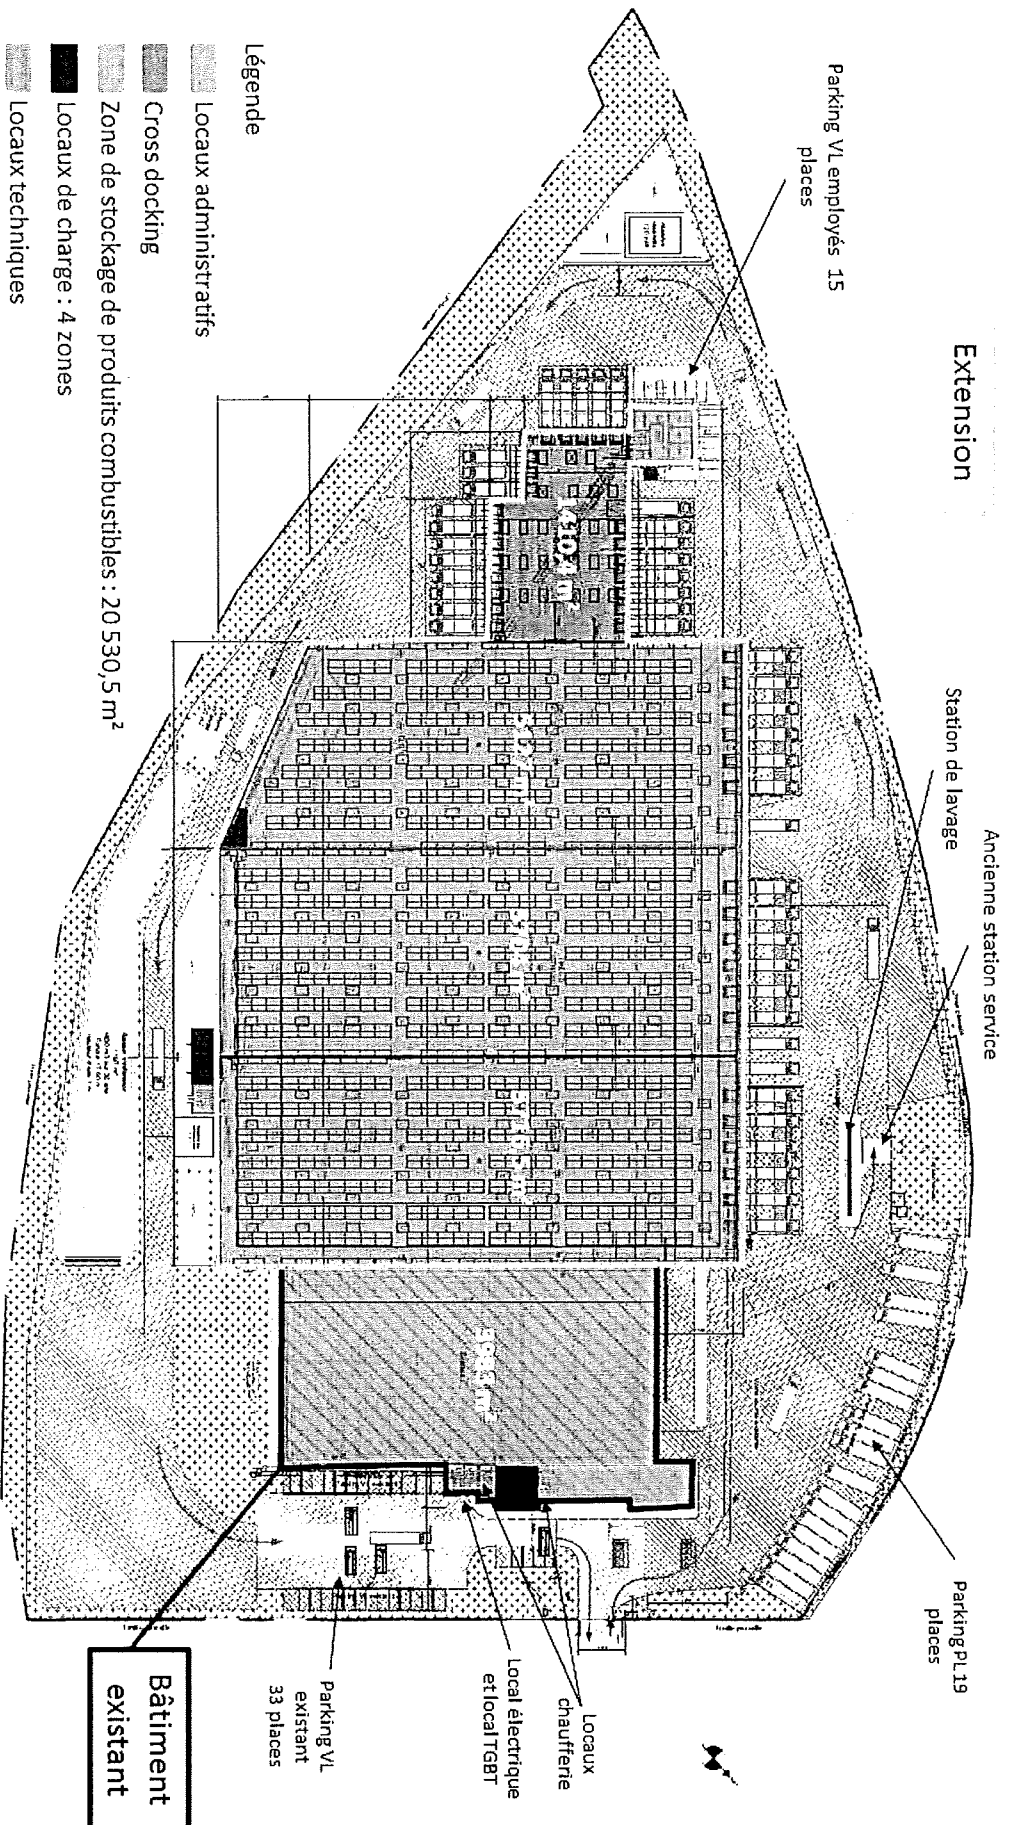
plan de masse de l'entrepôt avec extension – Source : Fayat
